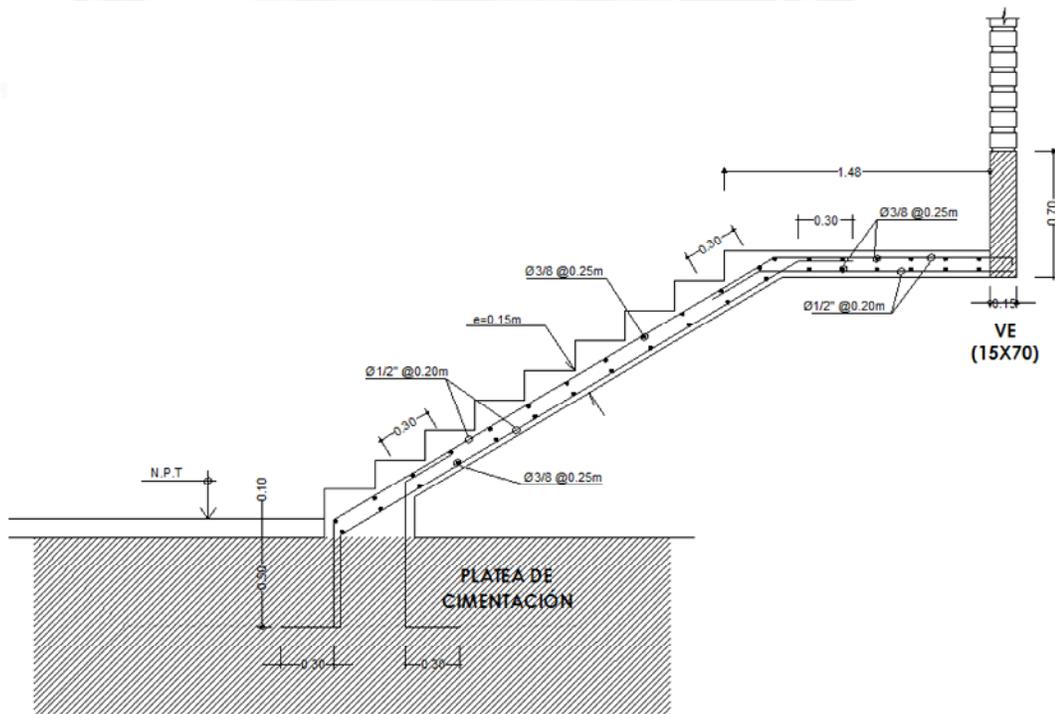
Esquema del Armado Final para la Escalera del Ejemplo.
